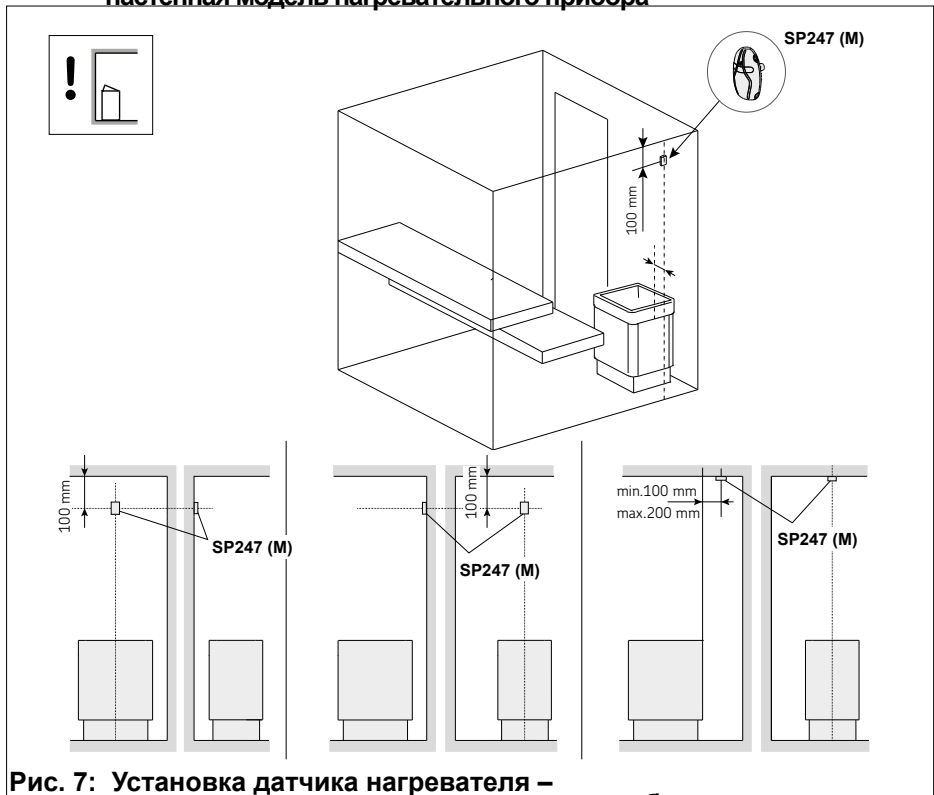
Установка датчика нагревателя – напольная модель нагревательного прибора
